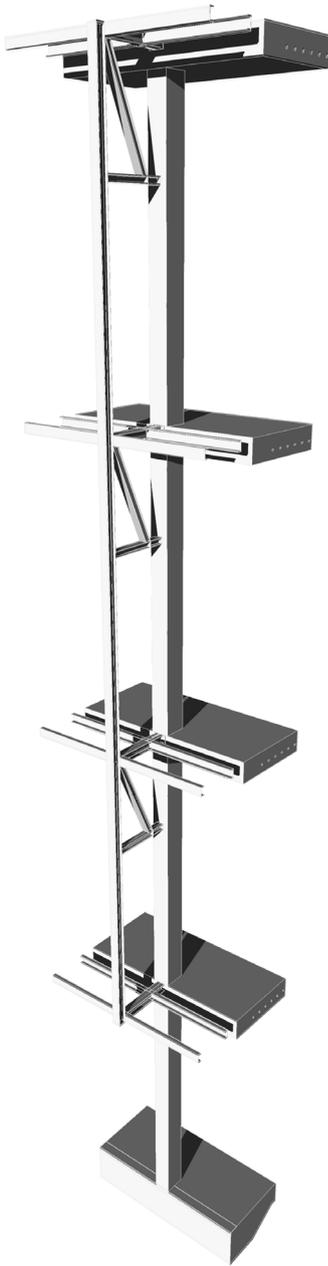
Fassade _ Tragstruktur Stahlbeton / Wartungssteg
